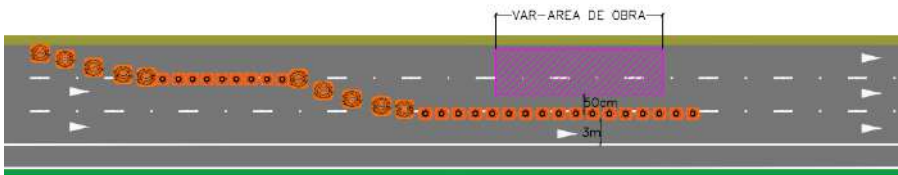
Posicionamento de dispositivos de canalização – Pista com 4 faixas (caso 1)
